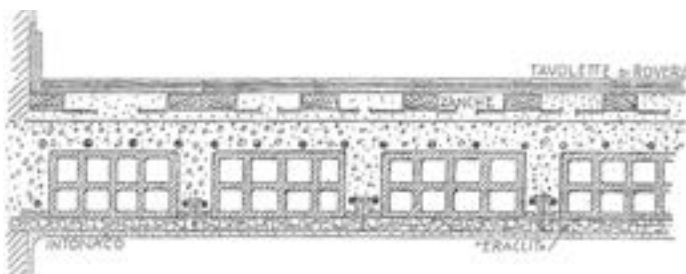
Solaio costituito da blocchi cavi in laterizio e fondello piano in lastre di "Eraclit" (rif. Vacchelli G., "Le costruzioni in calcestruzzo ed in cemento armato", Hoepli, Milano, 1921).
